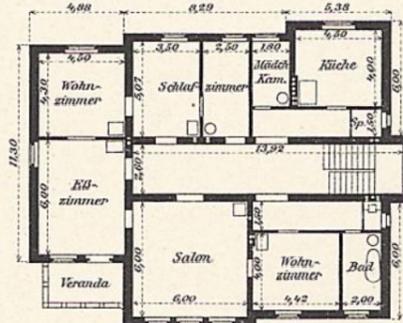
Beamtenwohnhaus. (A im Lageplan Abb. 13).
